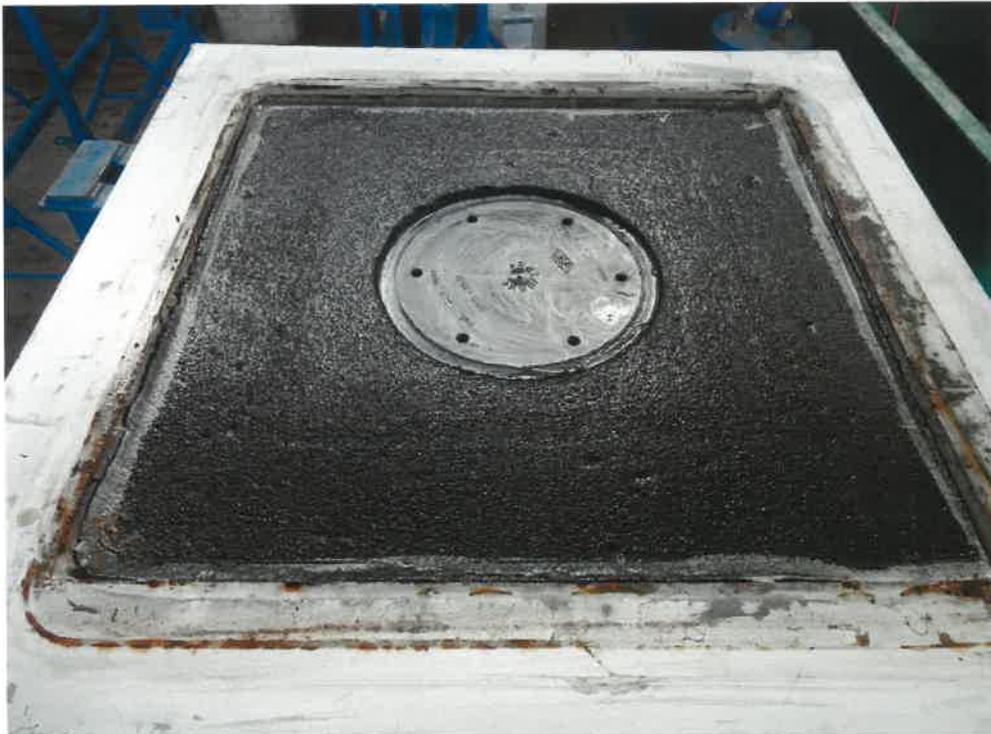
PMBC Oberfläche nach vierwöchiger Wasserdruckbeanspruchung mit 1 bar
